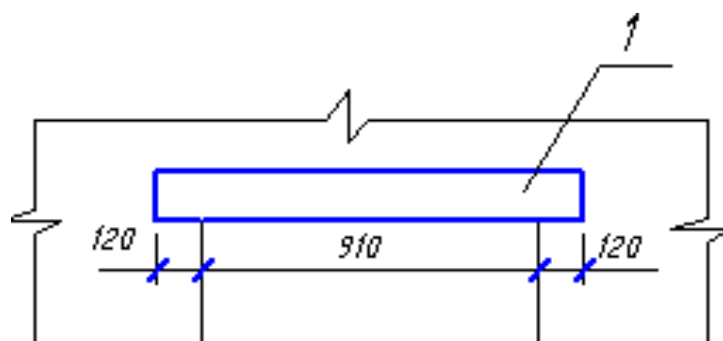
Схема опирания ненесущей перемычки над проемом
